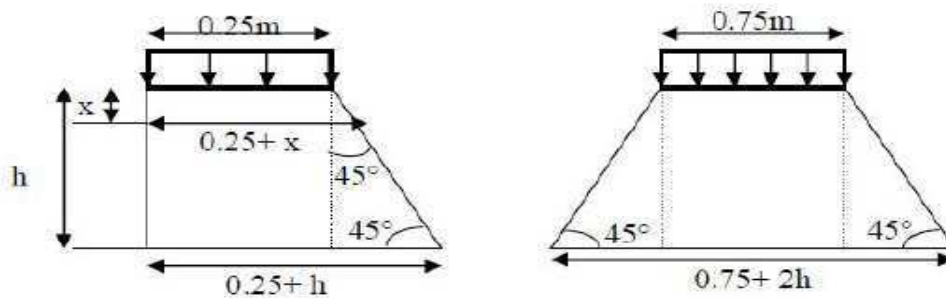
Poussée de la charge locale située en arrière du mur r
